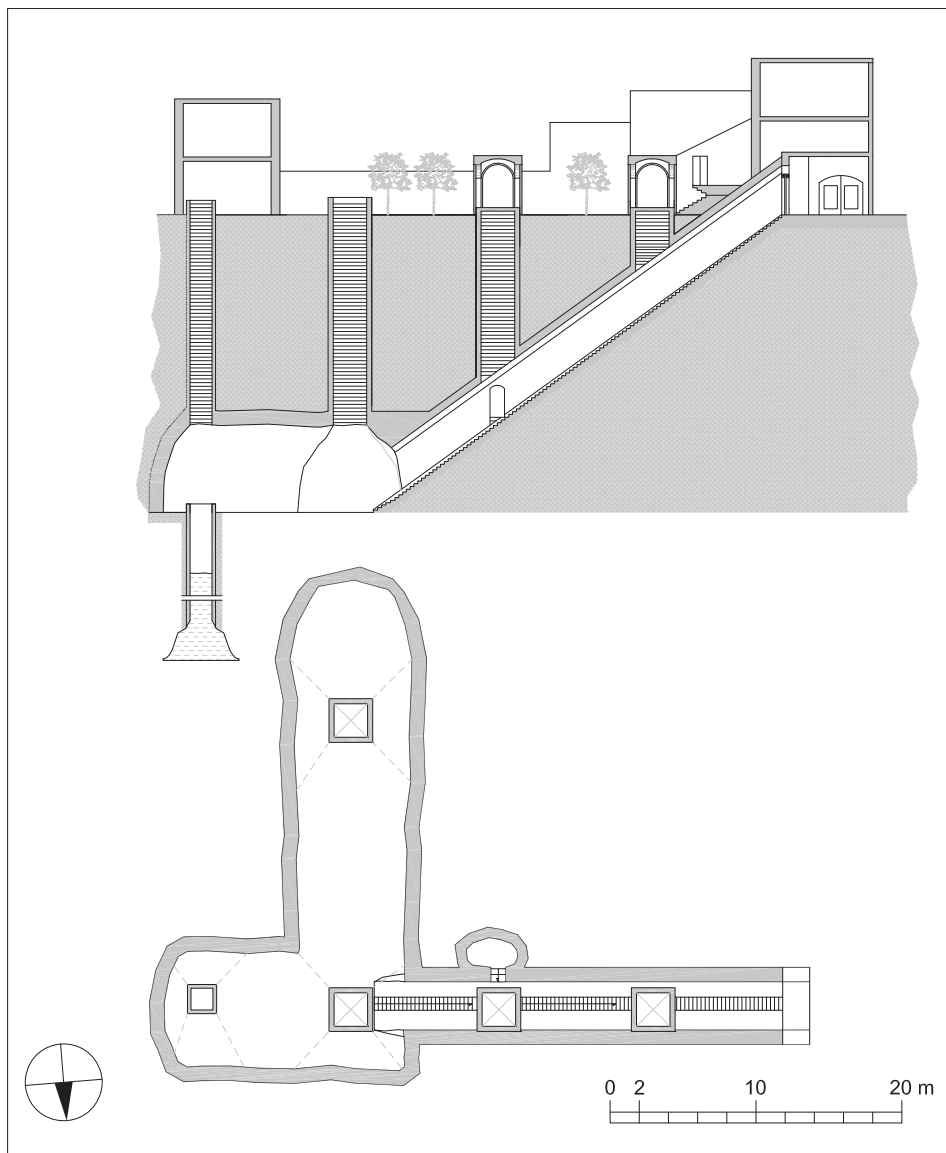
Gallo, cantina C10. Pianta e sezione trasversale.
